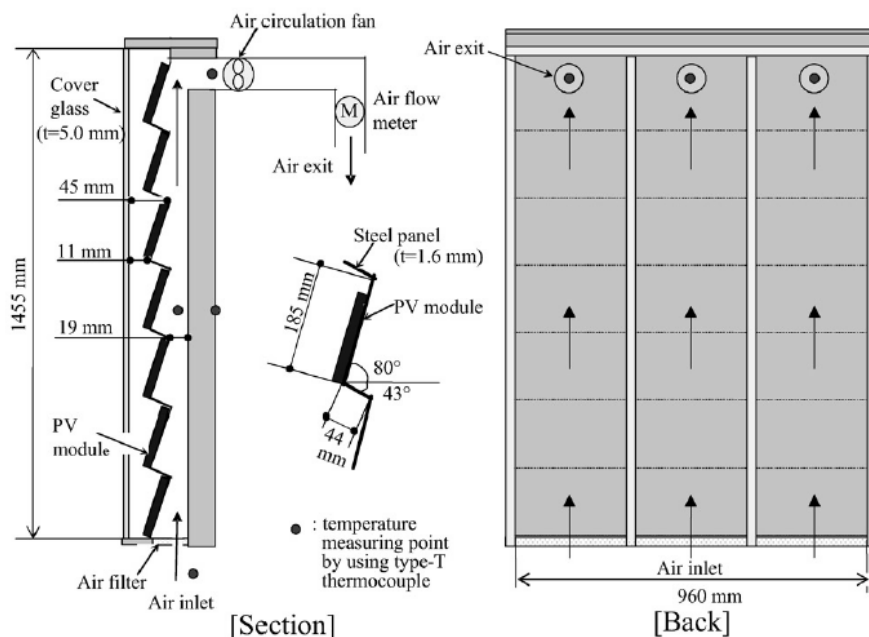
Esquema de PV/T en fachada refrigerado mediante aire. [13]
